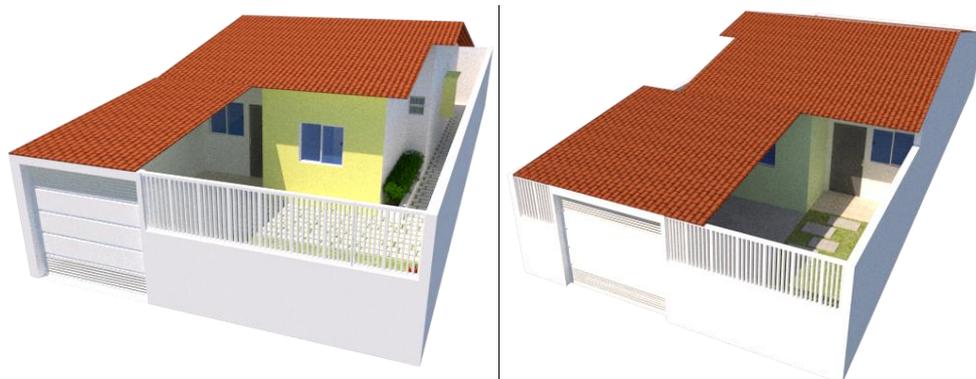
Proposta orientada à Sudoeste - Fachada frontal
